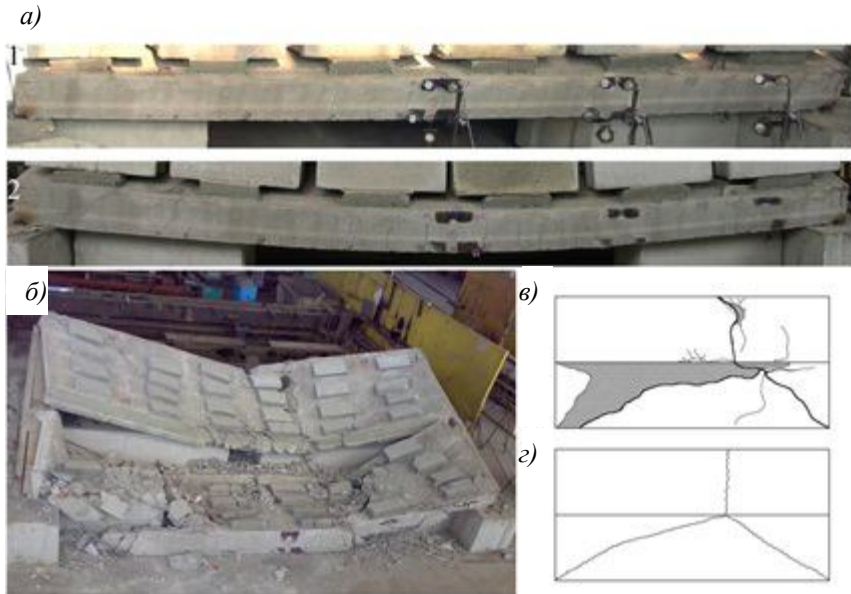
Общий вид трещинообразования в продольном ребре нижней плиты фрагмента складчатого покрытия (а); общий вид разрушения фрагмента складчатого покрытия (б); схемы разрушения фрагмента складчатого покрытия: опытная (в) и расчетная (г)
